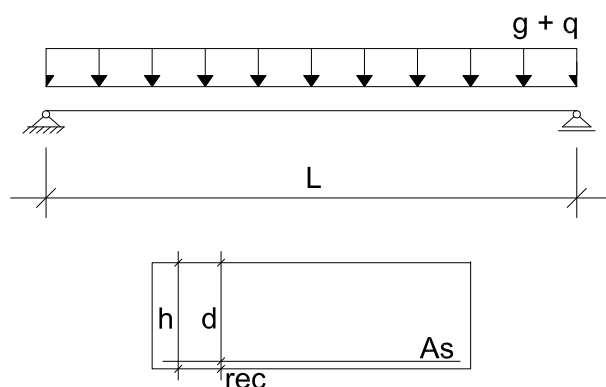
Vão de uma laje simplesmente apoiada e a sua secção transversal
